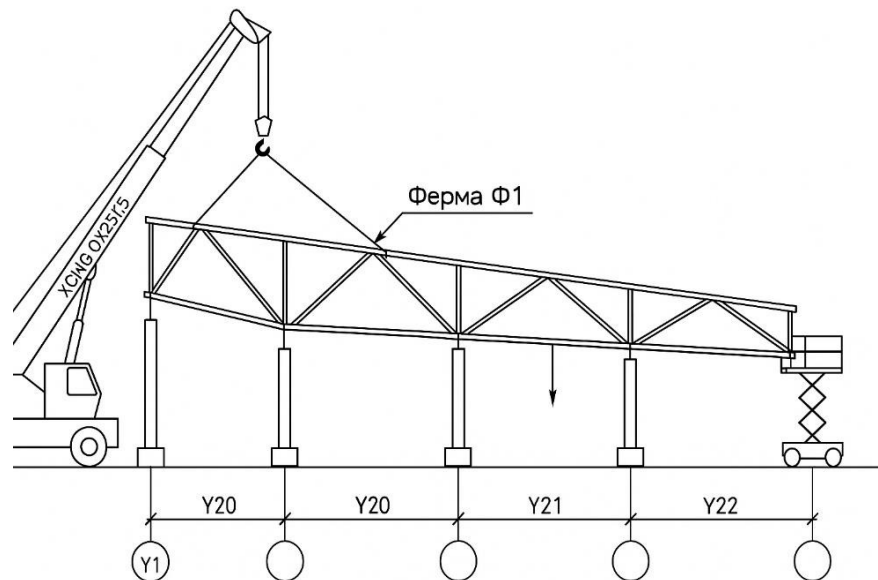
Схема монтажу ферми Φ1 в осях Y19- Y22
